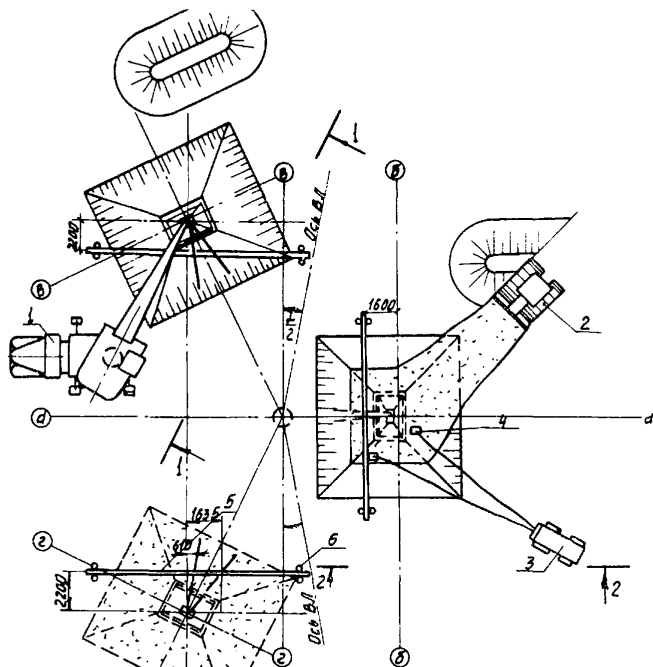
Установка элементов фундамента опоры ПУБ 35-1 и ПУБ 110-1 с обратной засыпкой котлована
